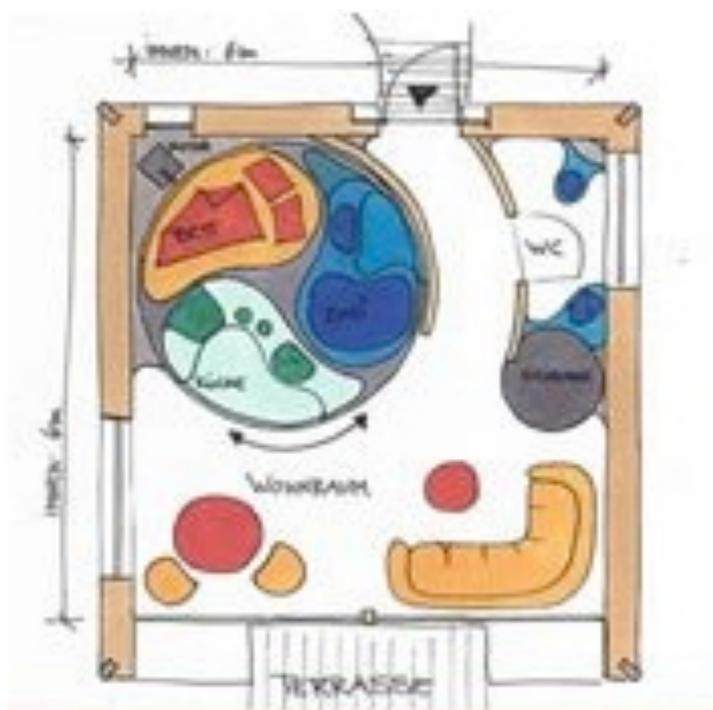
Planta baixa (MODERN DESIGN, 2016).
